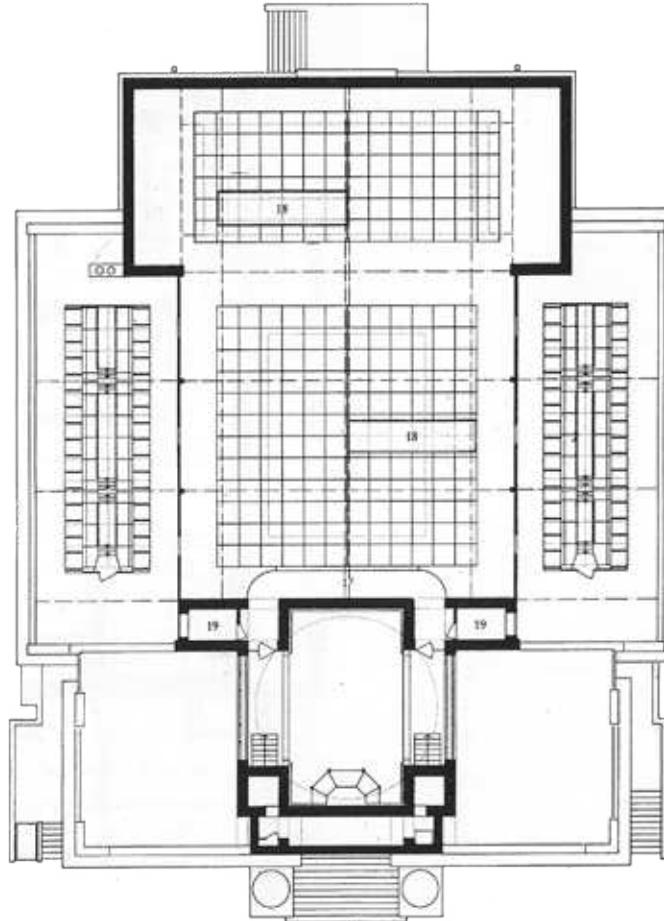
Grundriss Dachgeschoss, Maßstab ca.1:350, 1986
